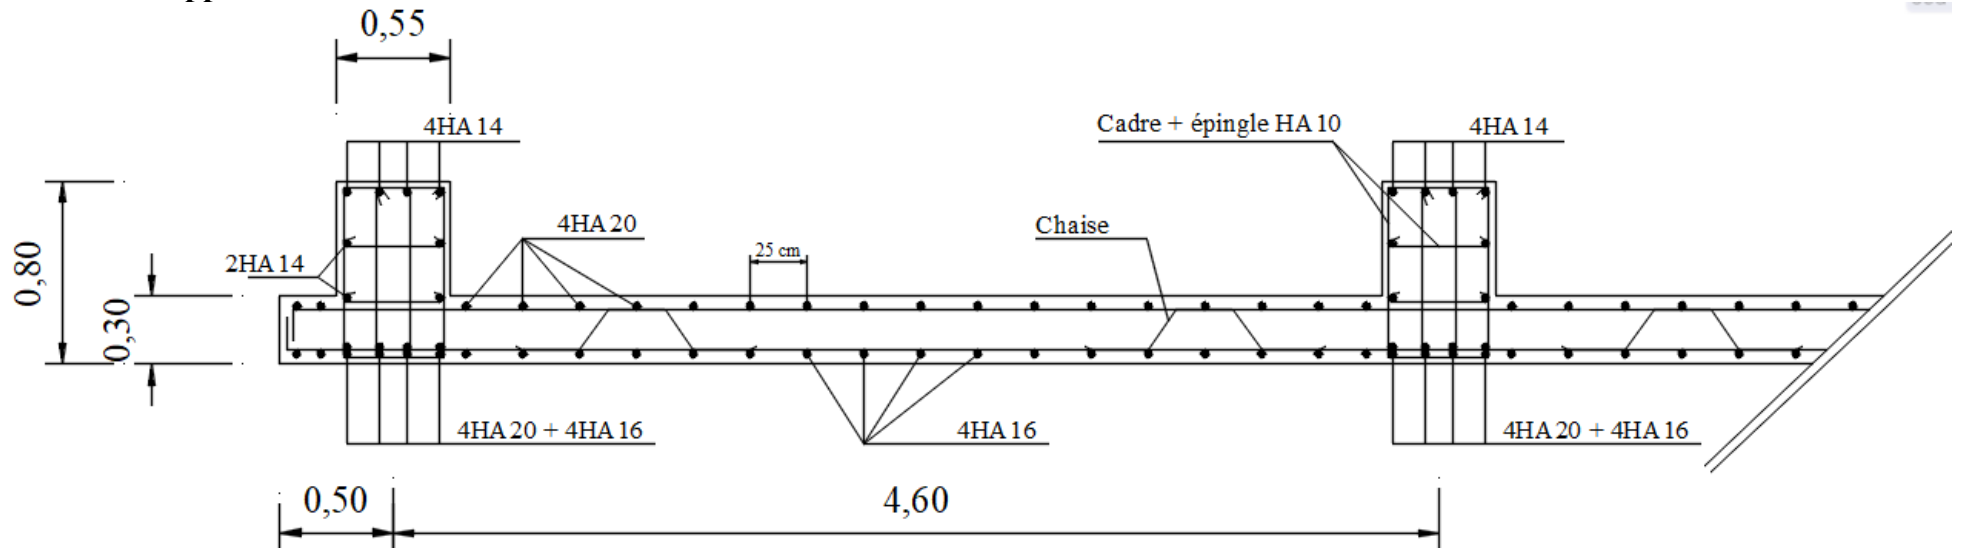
Schéma de ferrailage du radier (aux appuis) sens x-x.
